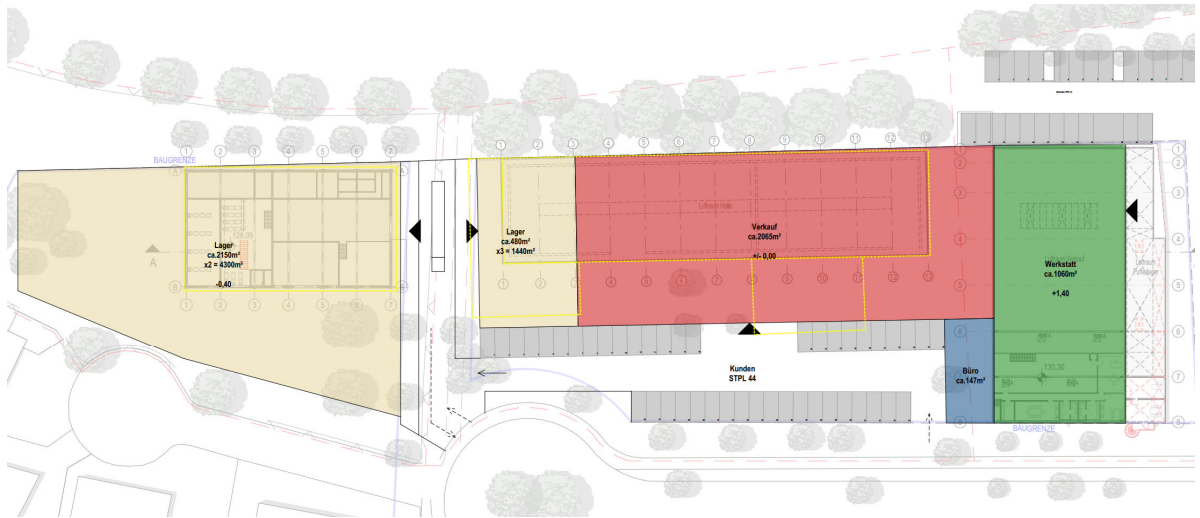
Lageplan Erweiterung / Neubau Zweiradcenters Markgraf & Linn [1]
